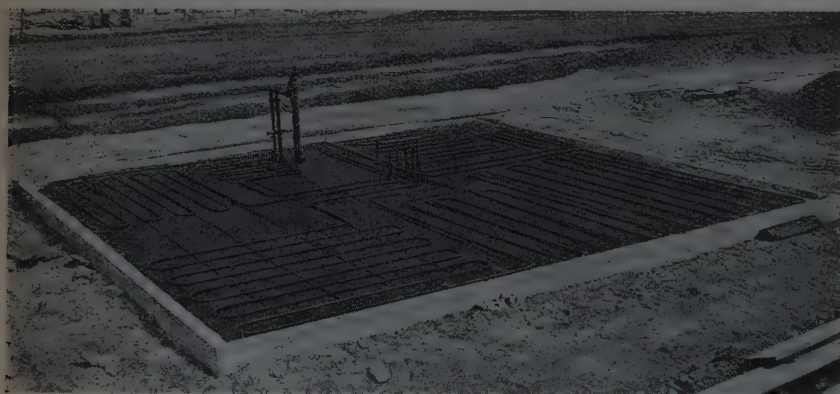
Tubes placés sur une couche en béton au-dessus de pierres concassées.
